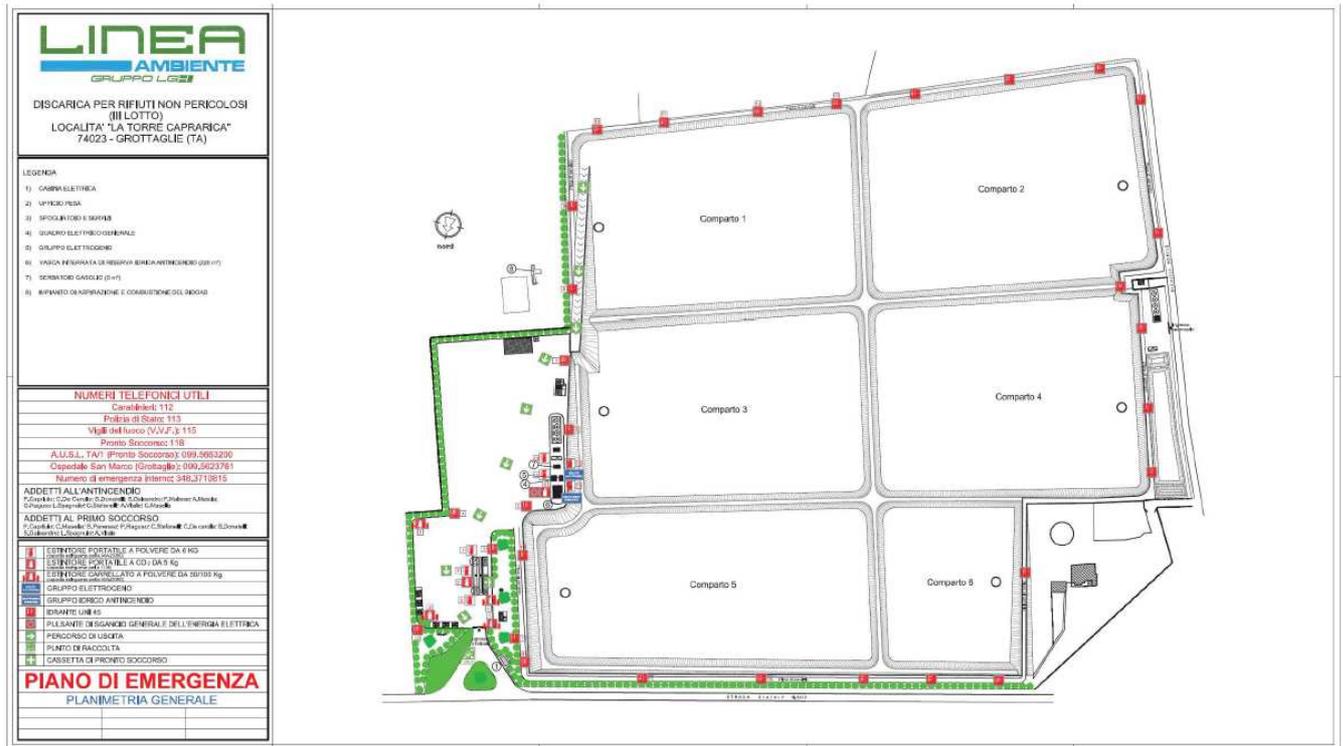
Planimetria Piano di Emergenza III Lotto
